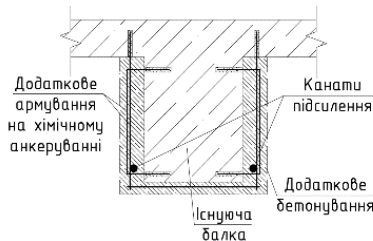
Нерозрізна балка, підсилена за допомогою напружених канатів з подальшим обетонуванням («Reinforcing internal post-tensioning»)
